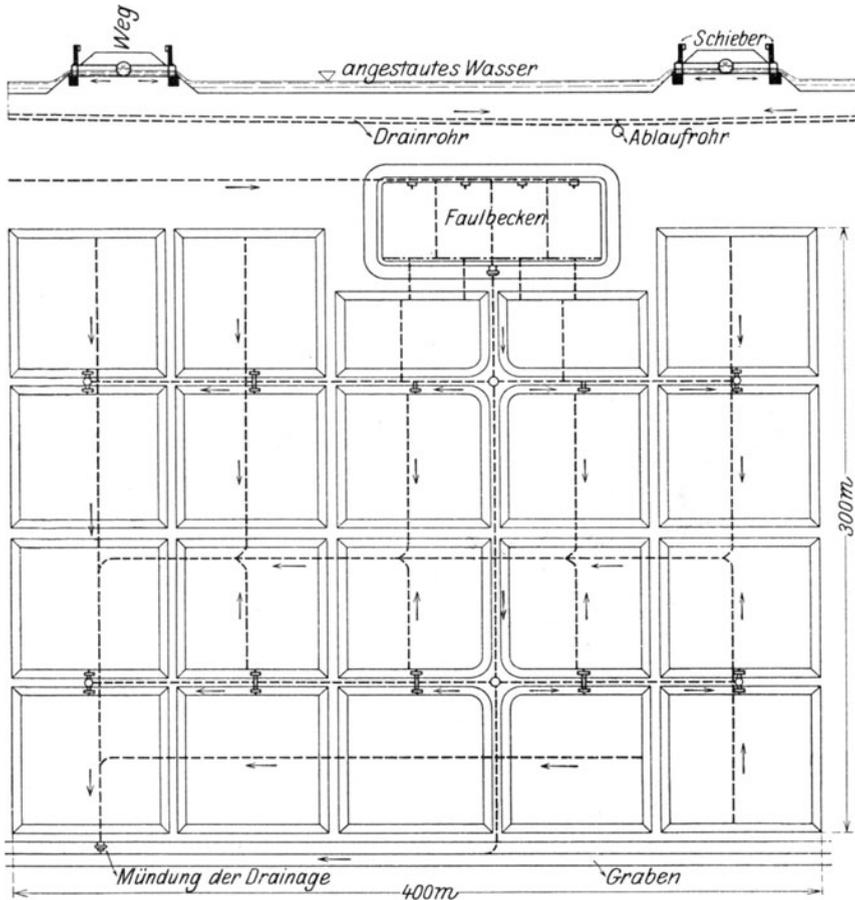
Durchschnitt und Grundriß einer Abwasserreinigungsanlage durch intermittierende Bodenfiltration mit Vorbehandlung der Abwässer.
